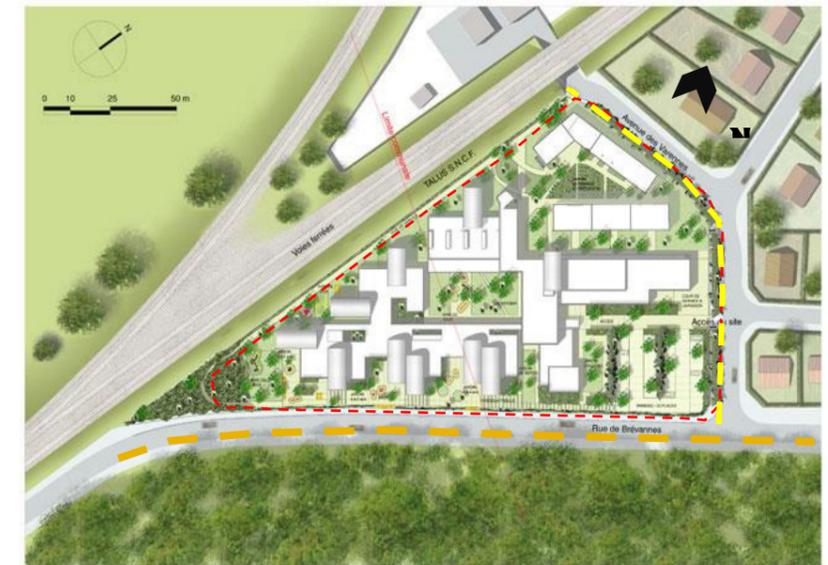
Plan de situation «Sucy-en-Brieé»¹⁰⁰
